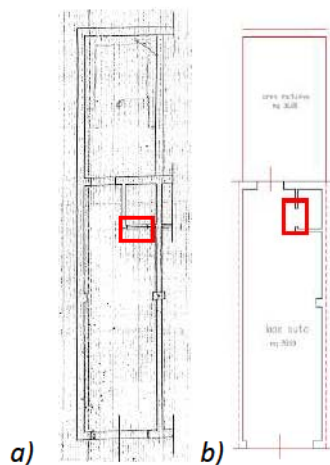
a) planimetria catastale del box auto; b) planimetria del box auto nello stato di fatto
